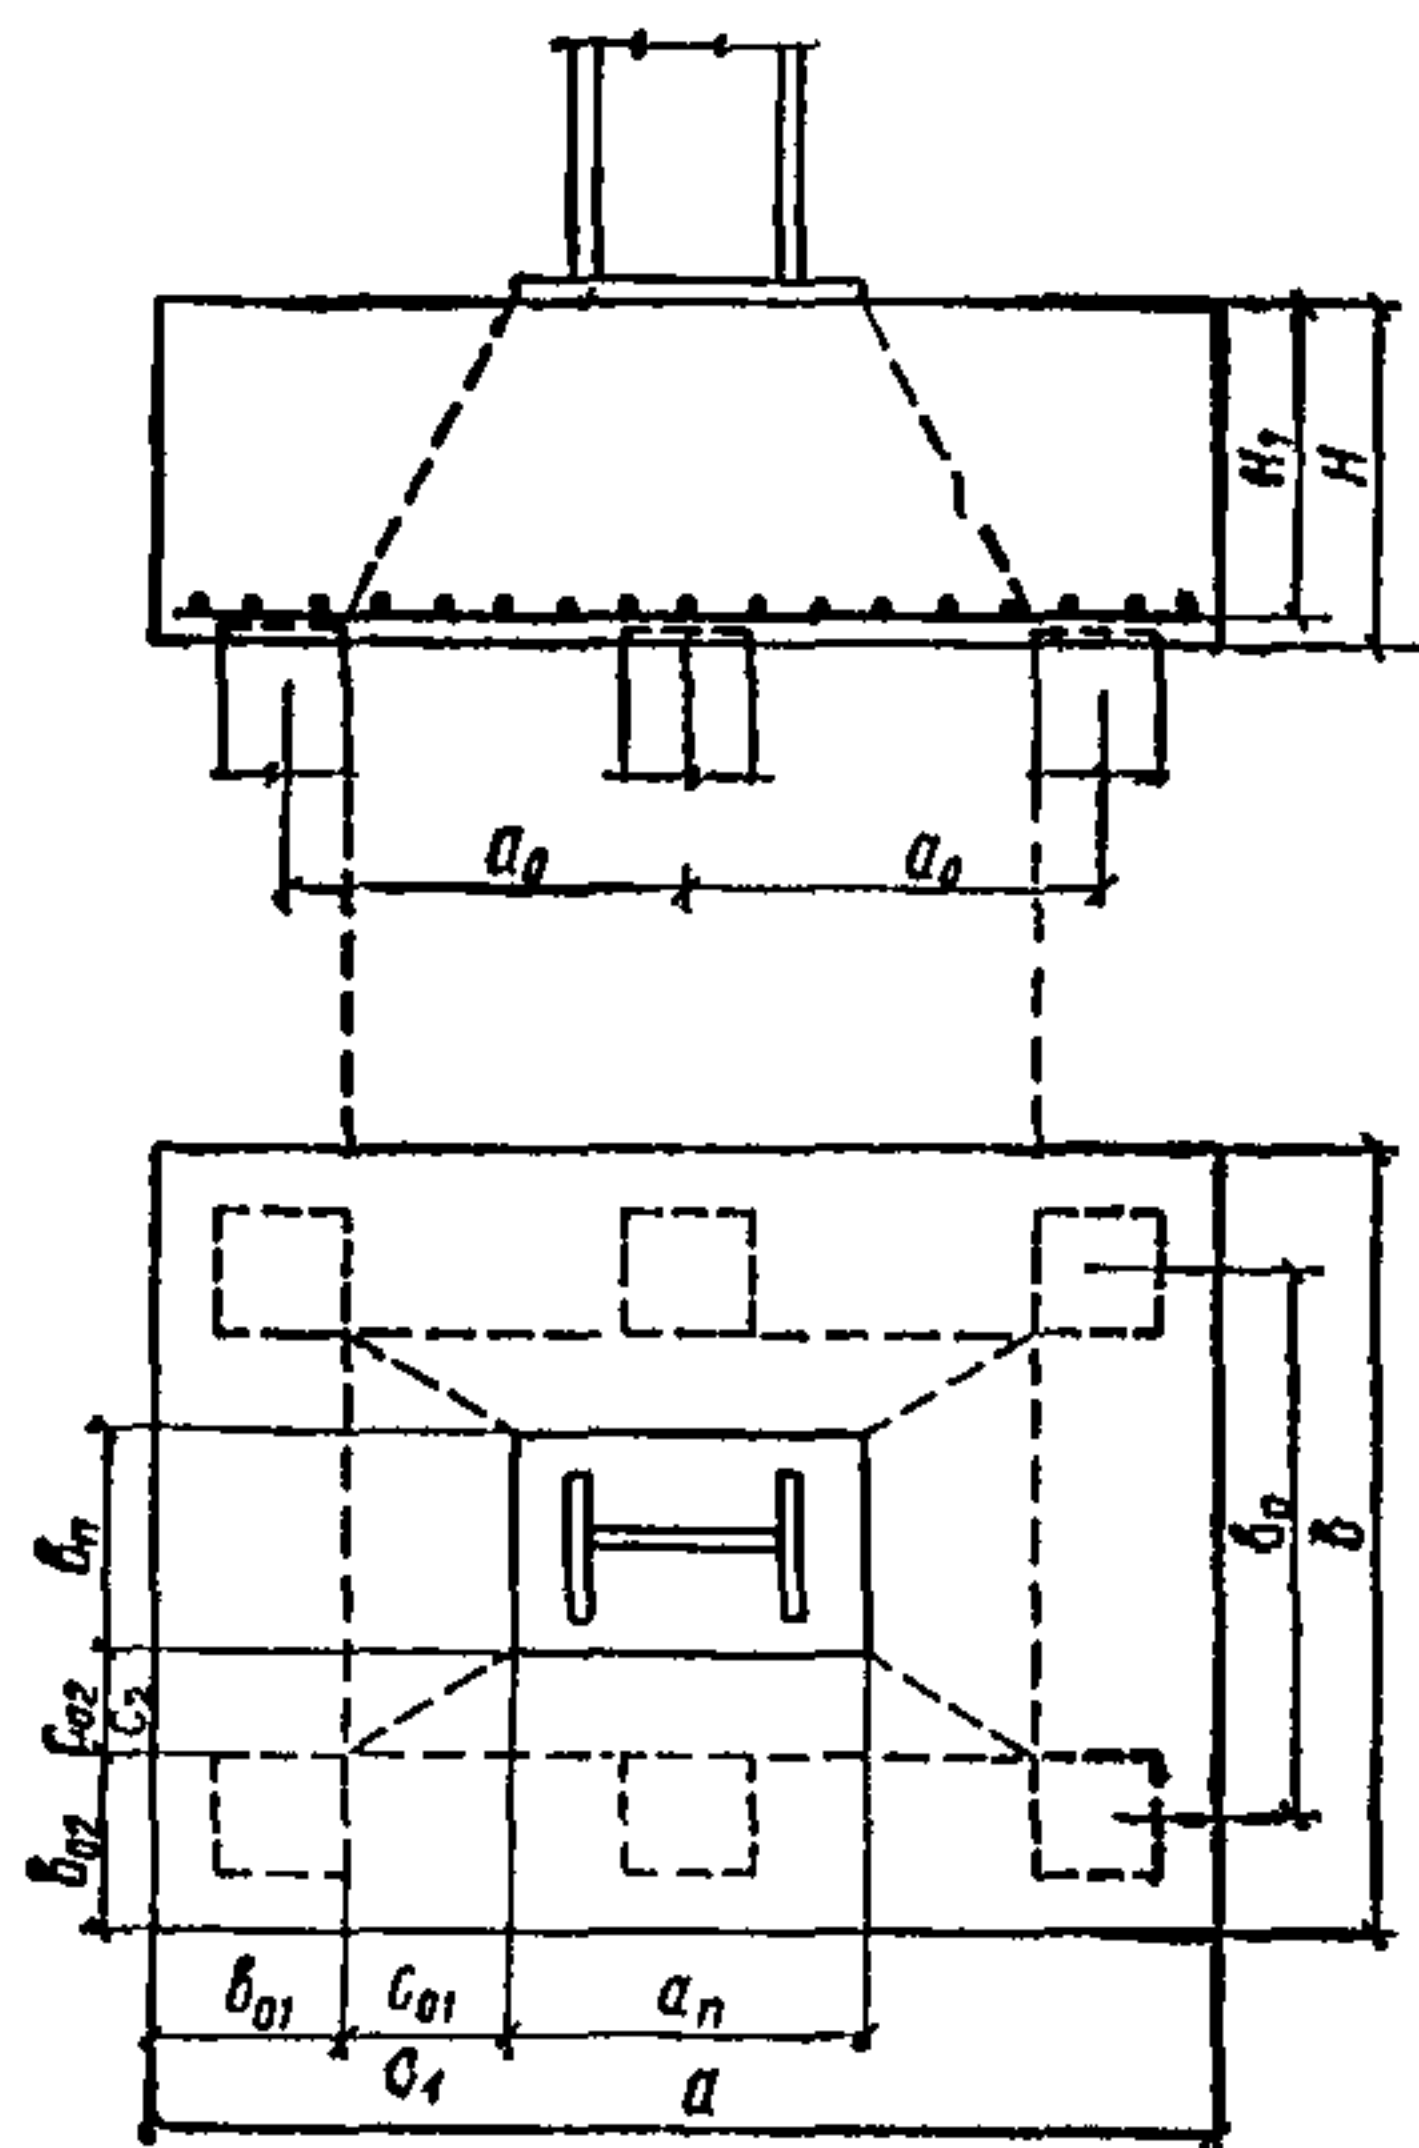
Схема образования пирамиды продавливания при стальных колоннах сплошного сечения
